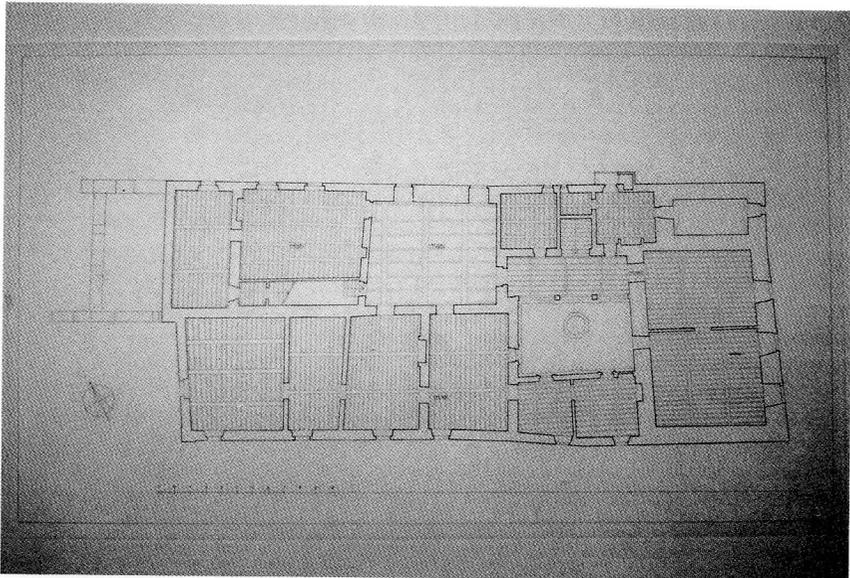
Pianta piano mezzanino, *ante* ultimi interventi.
